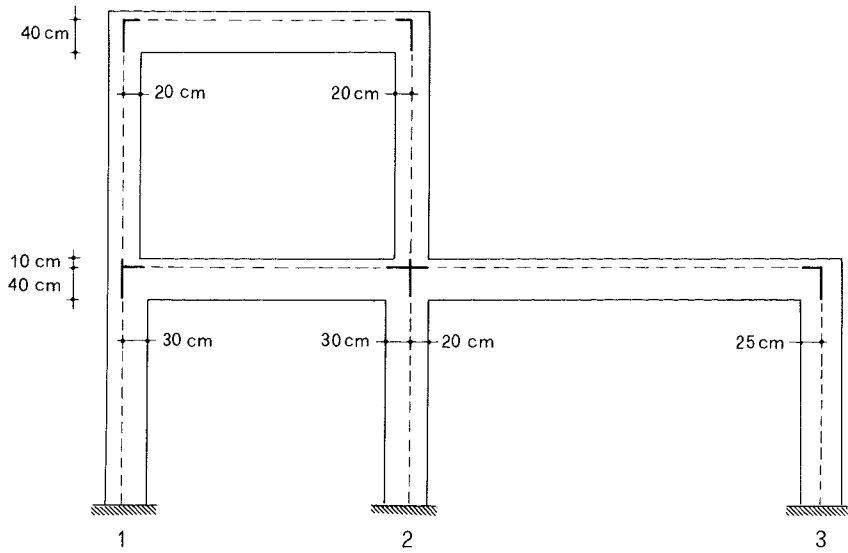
Schematizzazione di un telaio piano della struttura spaziale
